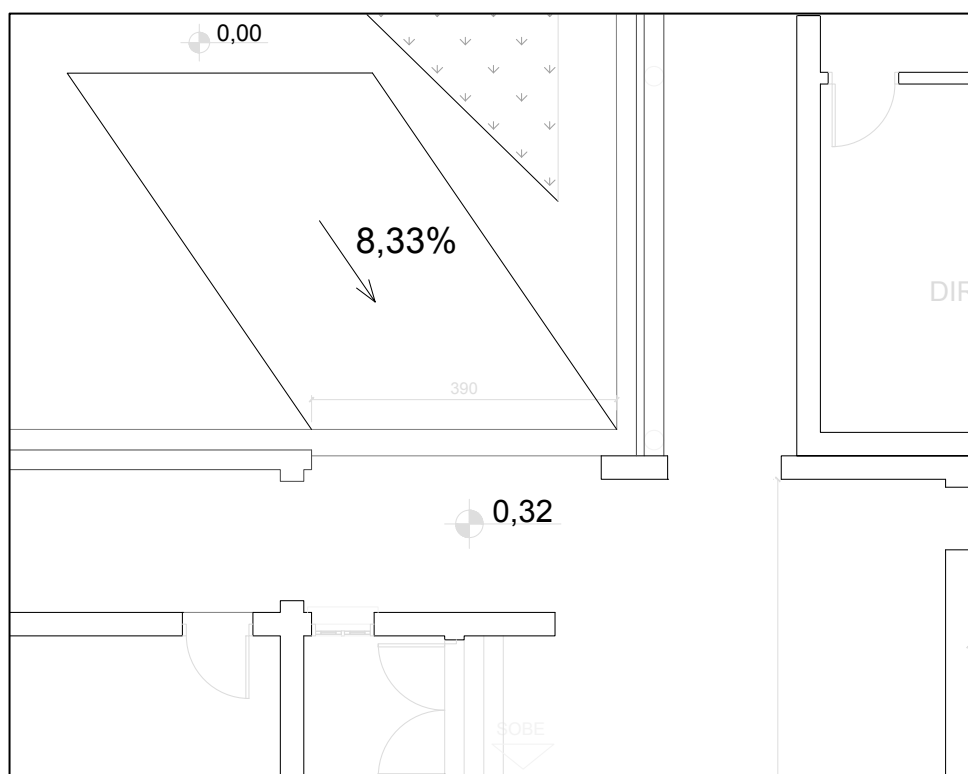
Proposta de alteração rampa 04. Fonte: autora.
